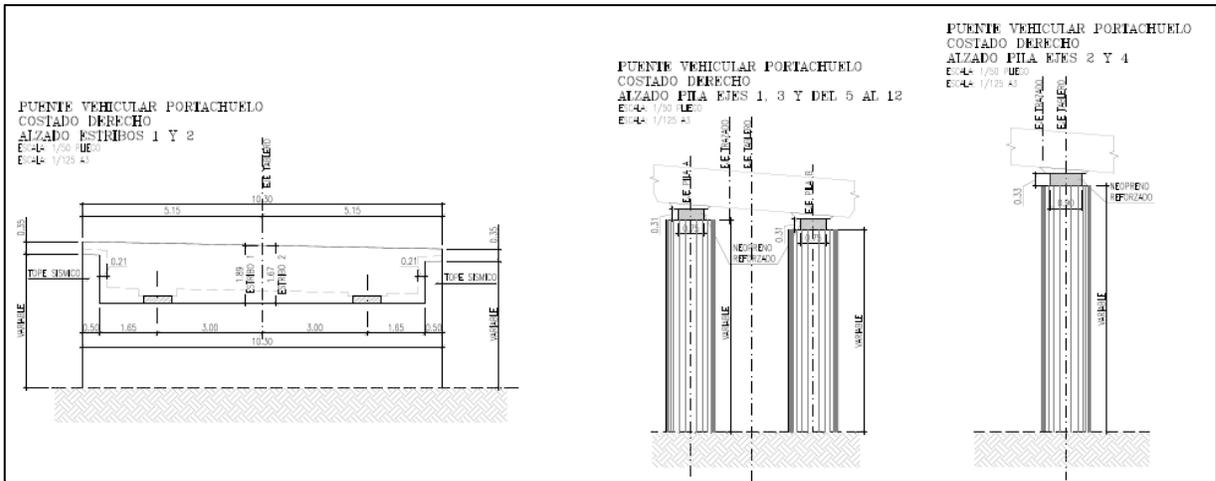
Vista General Puente Portachuel Oriental Estribos Y Pilas
